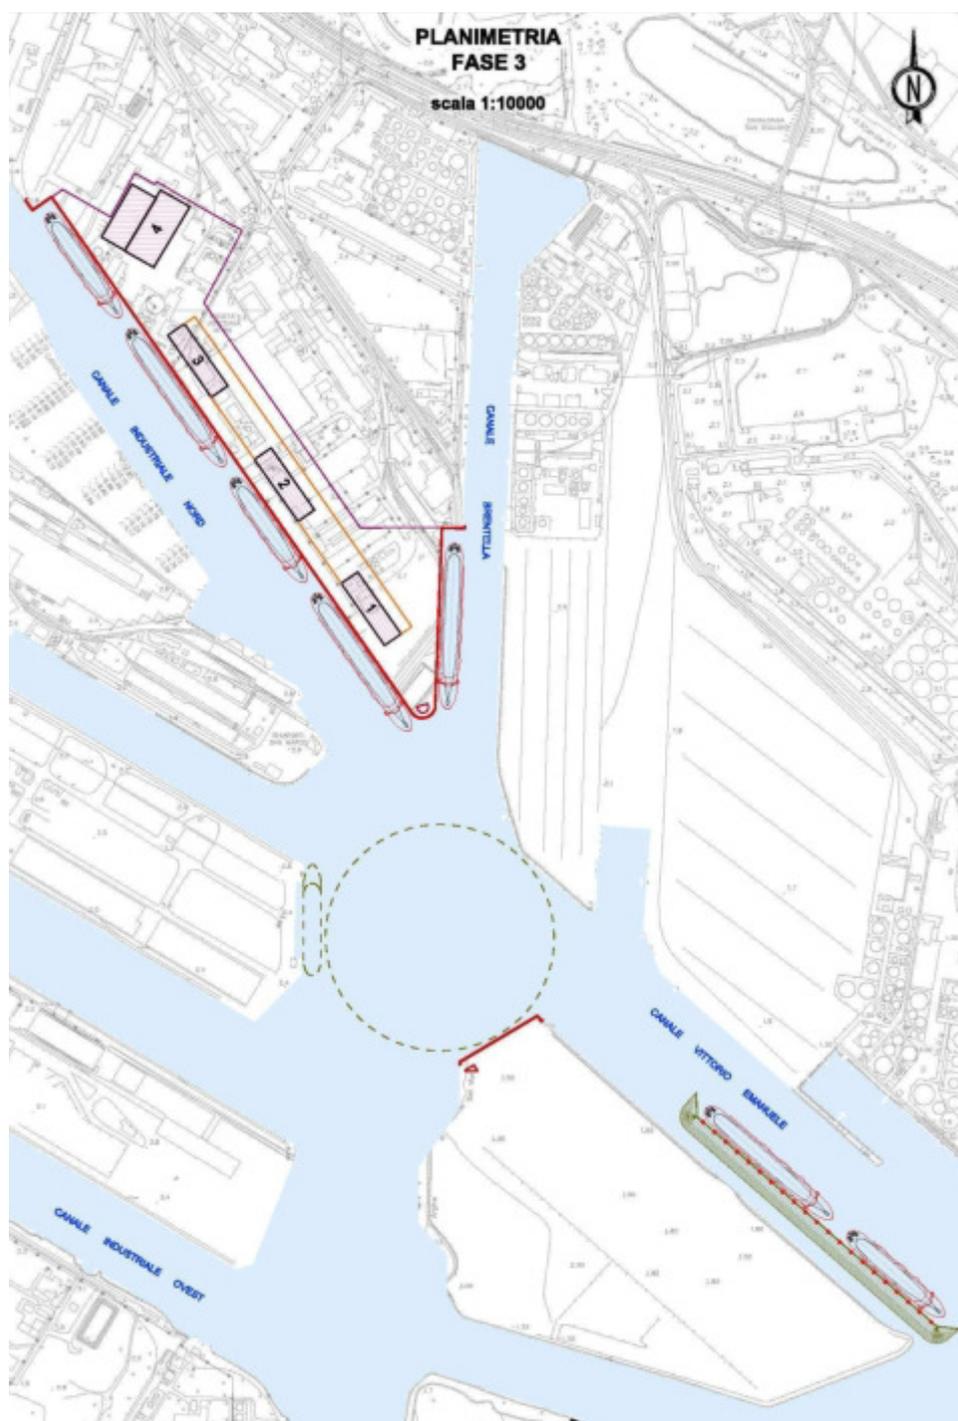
Planimetria dell'intervento, Fase 3. Fonte: Relazione Descrittiva Generale
